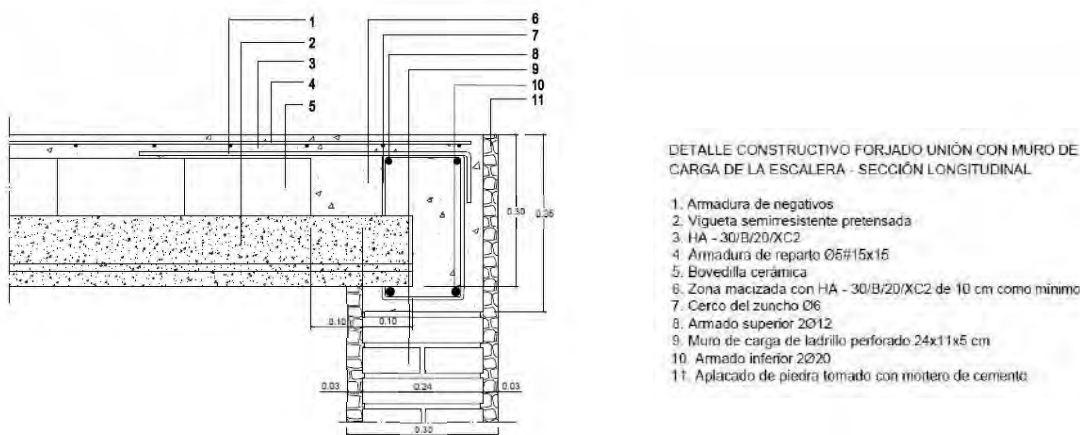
Detalle constructivo forjado – apoyo muro escalera. Fuente: propia.
